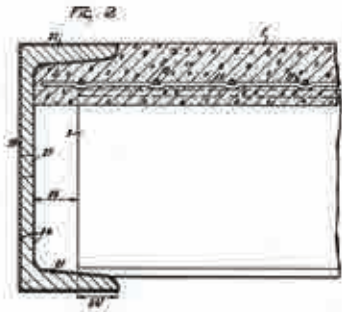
Patente 'Prefabricated section of a wall, floor or roof'
